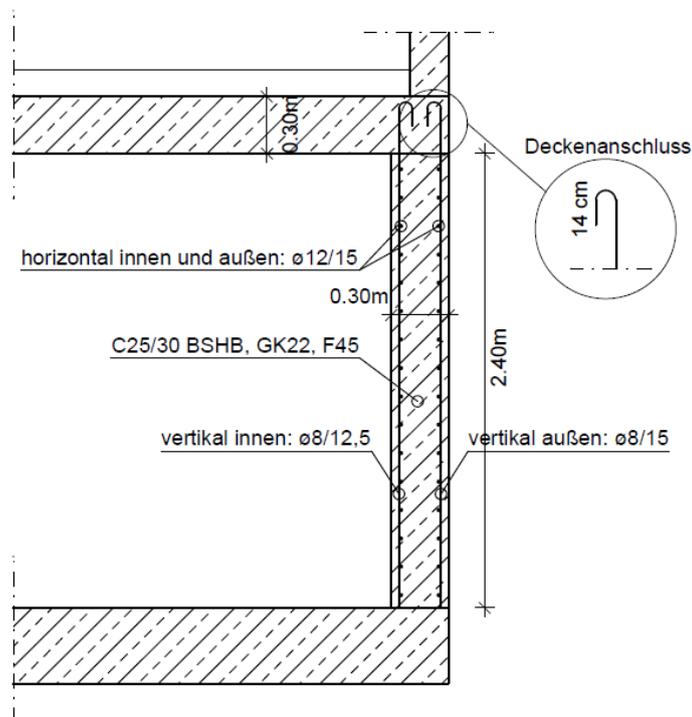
Ortbetonwand d = 30 cm [HÜB16]
